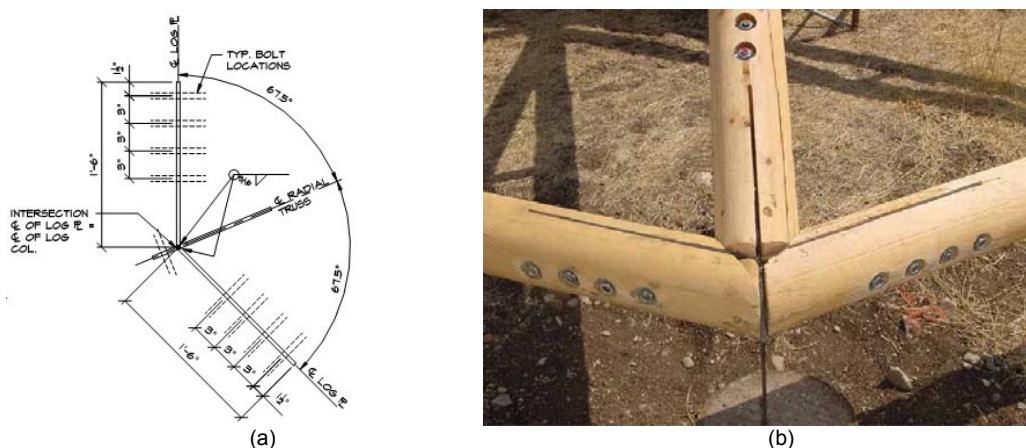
Ligações com chapas metálicas internas: (a) desenho da conexão no projeto; (b) detalhe da conexão. Fonte: BEAUDETTE CONSULTING ENGINEERS INC.
